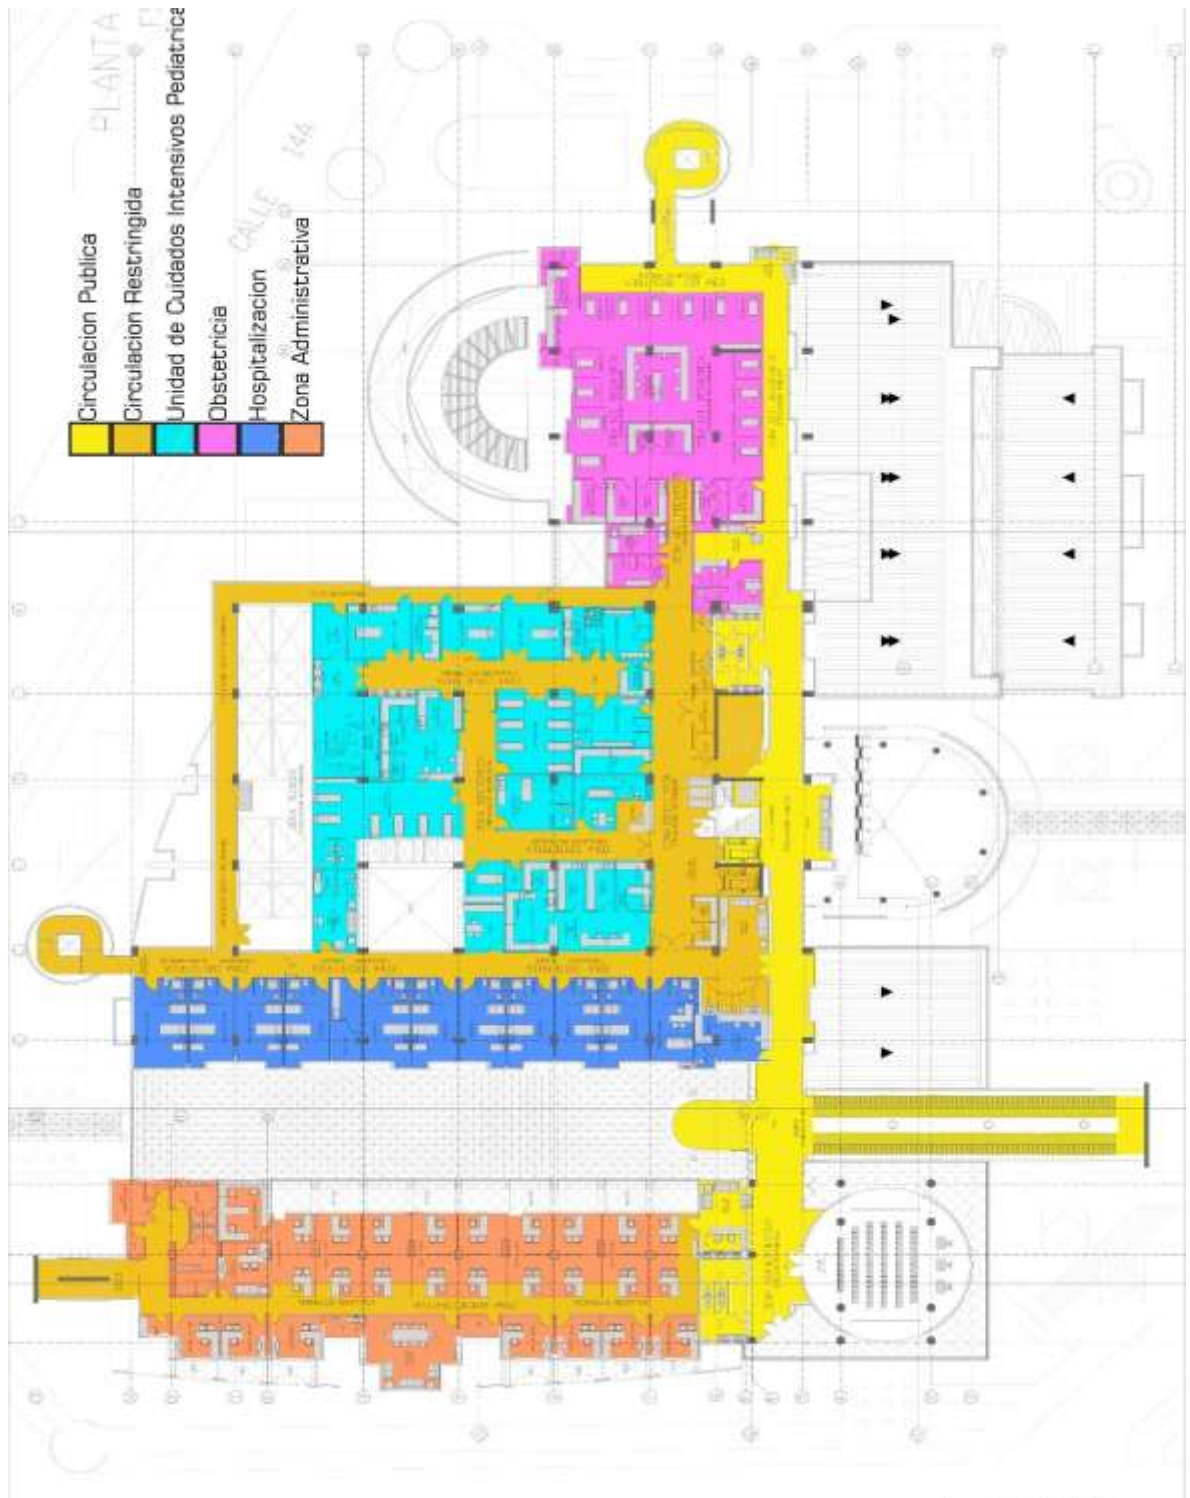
Planta tercer piso Hospital de Yopal, Casanare
